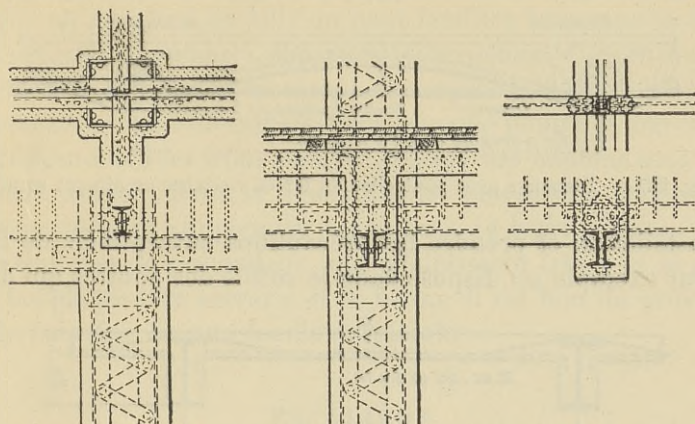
Plancher en béton armé avec armatures de résistance suffisante pour porter le coffrage.
